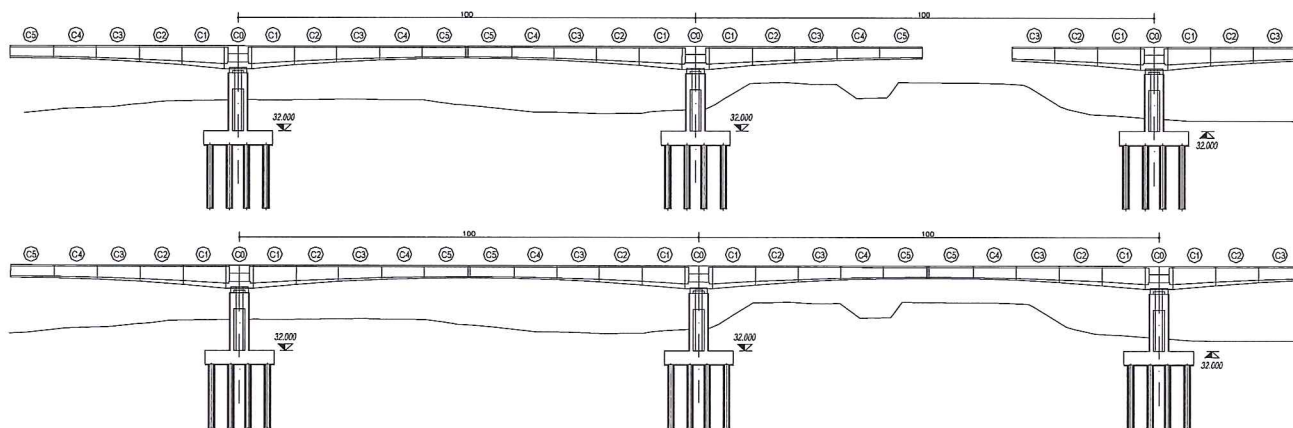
Realizzazione del collegamento tra due stampelle adiacenti.
